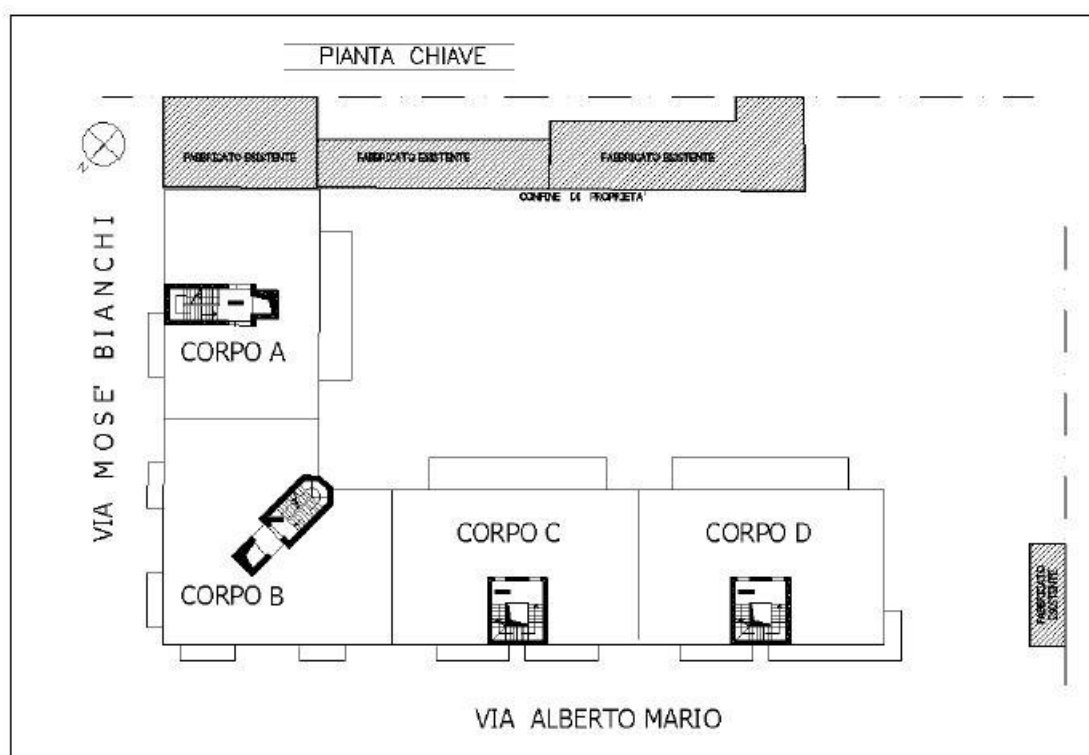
Pianta chiave della disposizione dei corpi edificati
